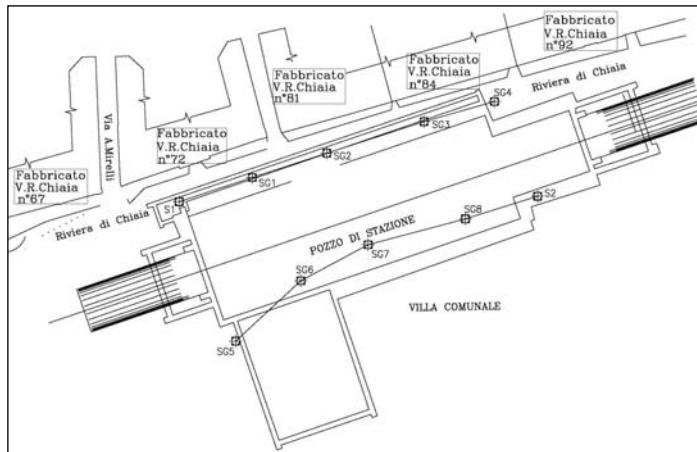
Planimetria pozzo stazione, raffigurante la collocazione di alcuni sondaggi effettuati per la campagna propedeutica alla stesura del Progetto Definitivo (2005).
